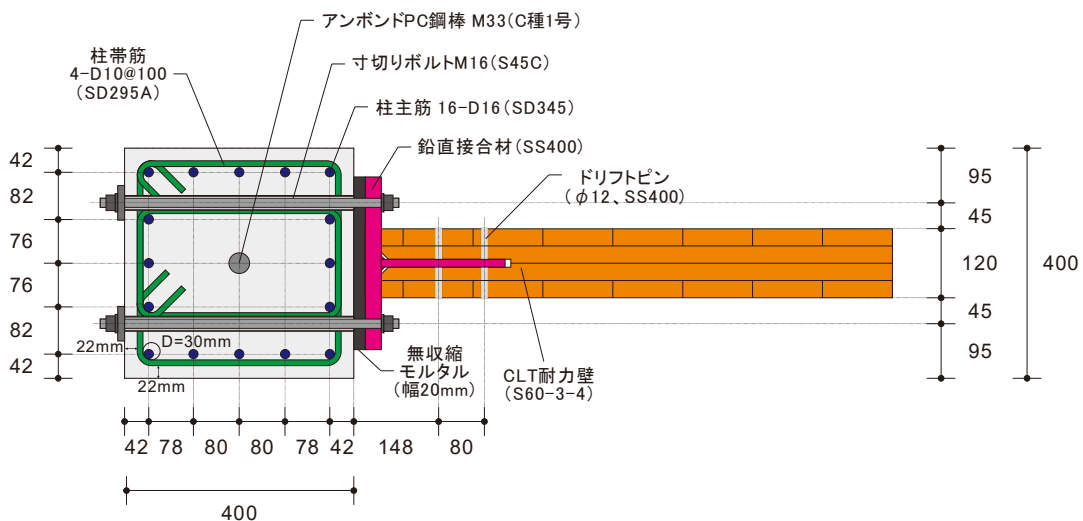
試験体 WB の CLT 耐力壁取り付け後の柱の断面図
